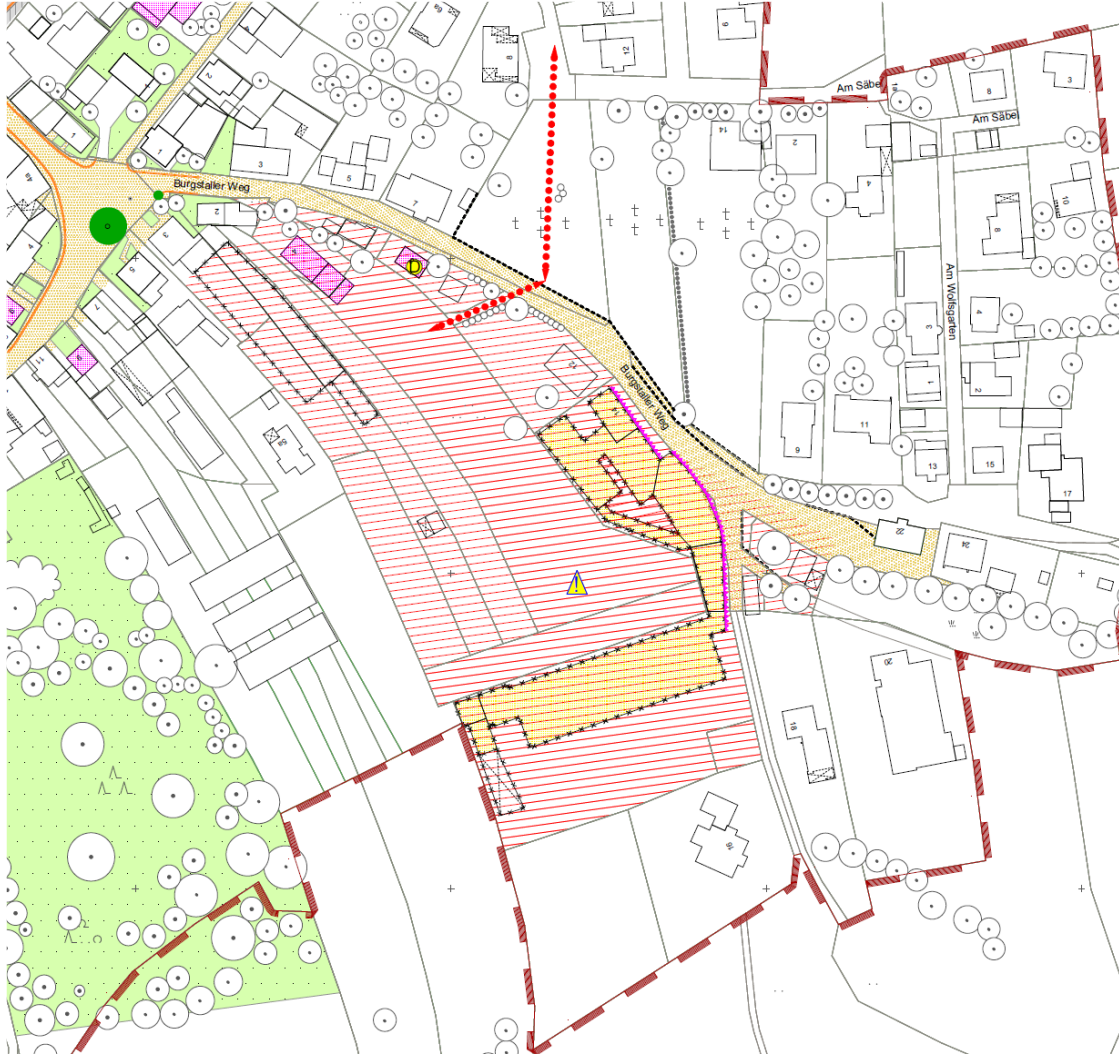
Ausschnitt Plan Maßnahmen / Konzept, Lauer+Lebok Architekten
